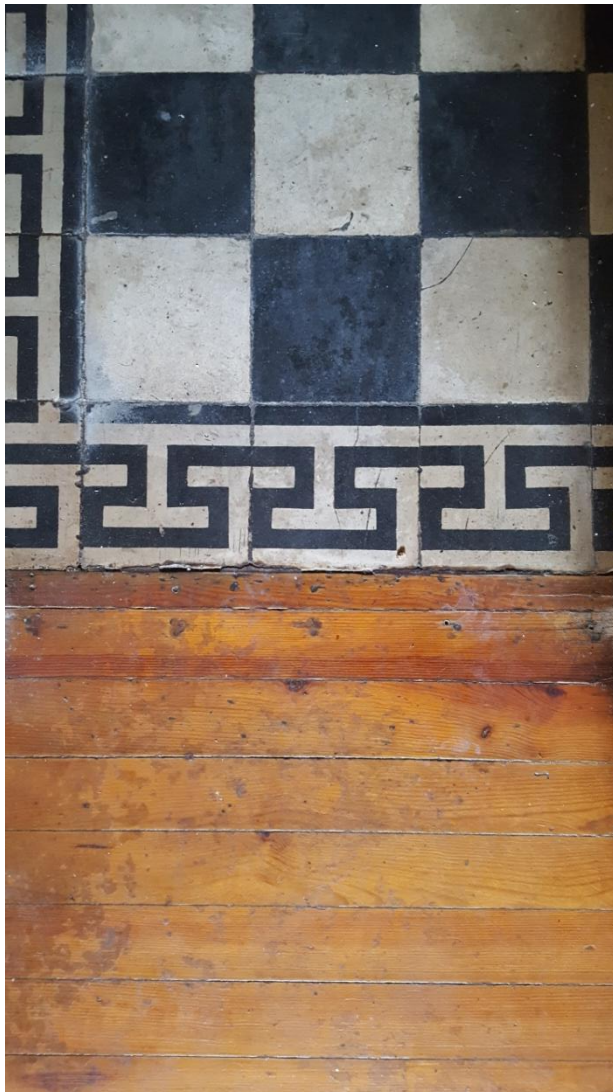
Fig. CXIV - Pavimento em madeira tipo casquinha e mosaico hidráulico
